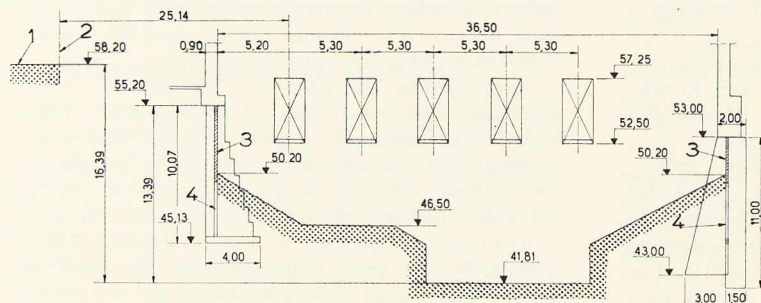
Détails des appuis des poutres au droit du mur à étaisonner.
